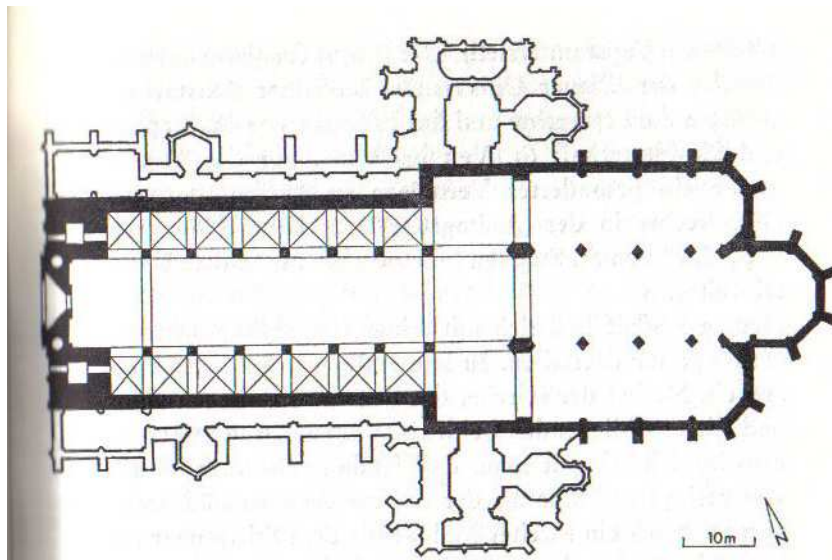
Schematischer Grundriss von St. Stephan nach Abriss der
